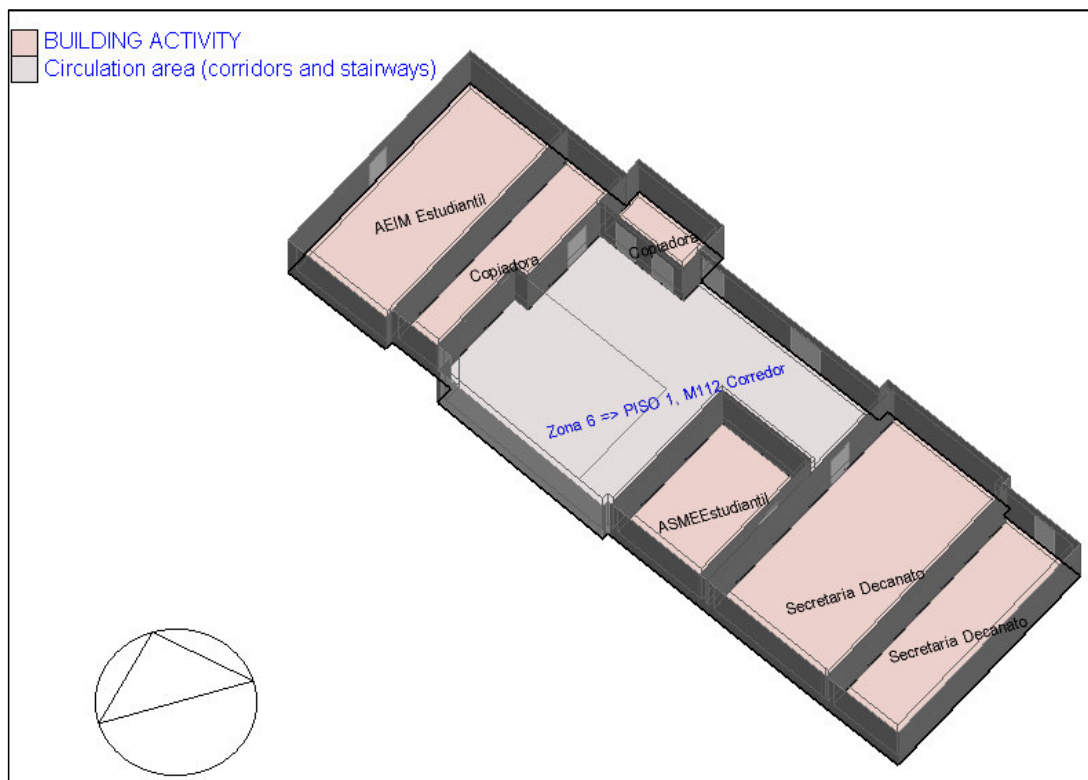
Modelo de la planta baja de la Facultad de Ingeniería Mecánica en *DesignBuilder* (Fuente: Autores)
